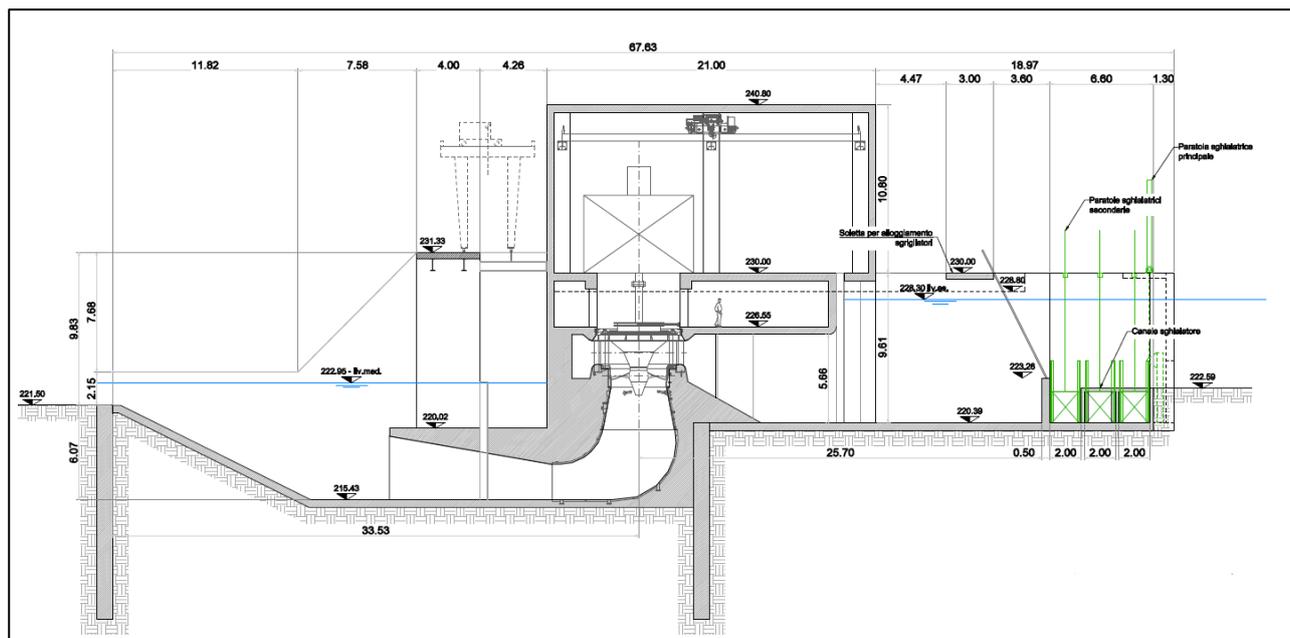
SEZIONE LONGITUDINALE SCHEMATICA DELL'EDIFICIO CENTRALE DI PRODUZIONE DI PROGETTO
